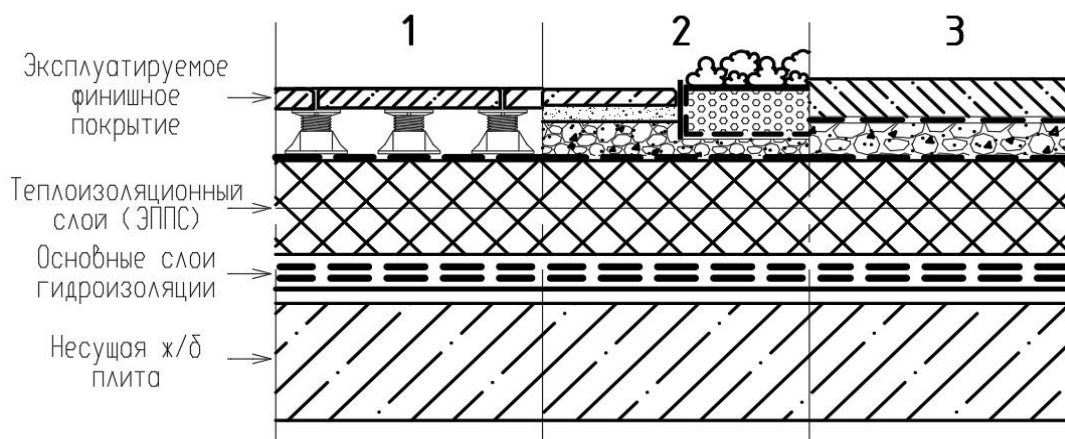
Конструкции основных сгруппированных вариантов инверсионной кровли: 1 – на опорах, 2 – без опор, 3 – кровля-паркинг
